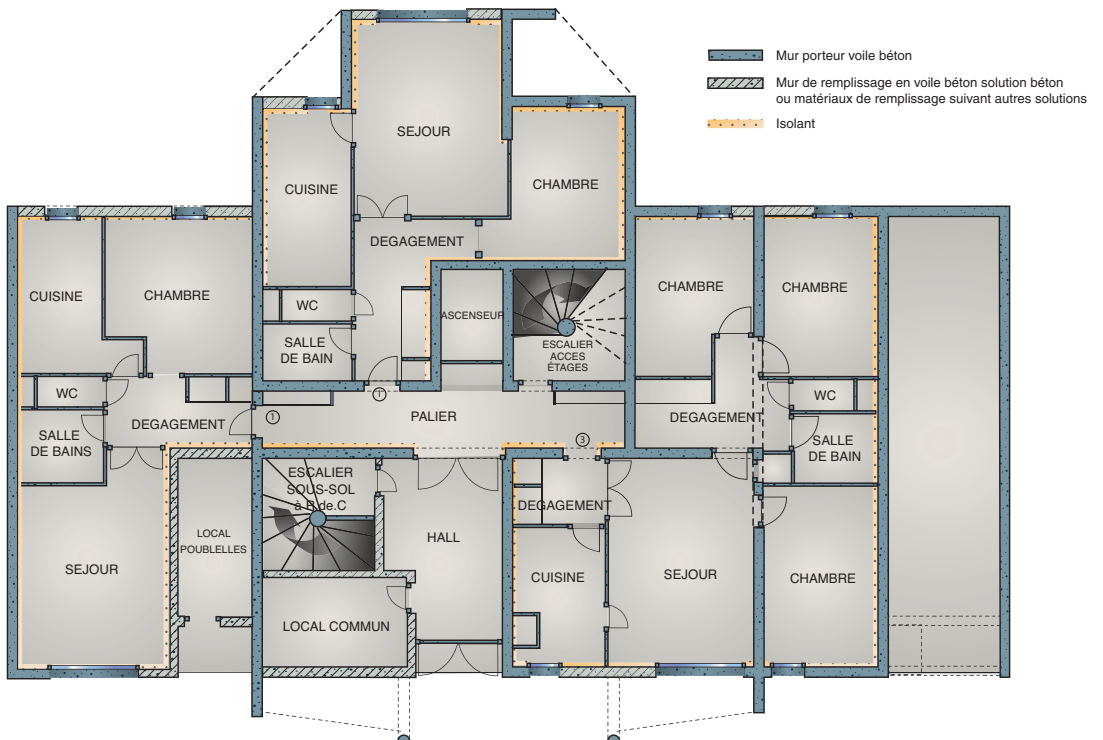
plan du rez-de-chaussée d'un logement collectif LC2
